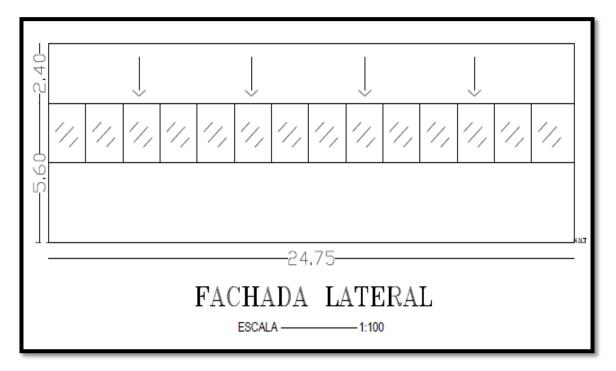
Fachada lateral de las instalaciones del CCICEV
